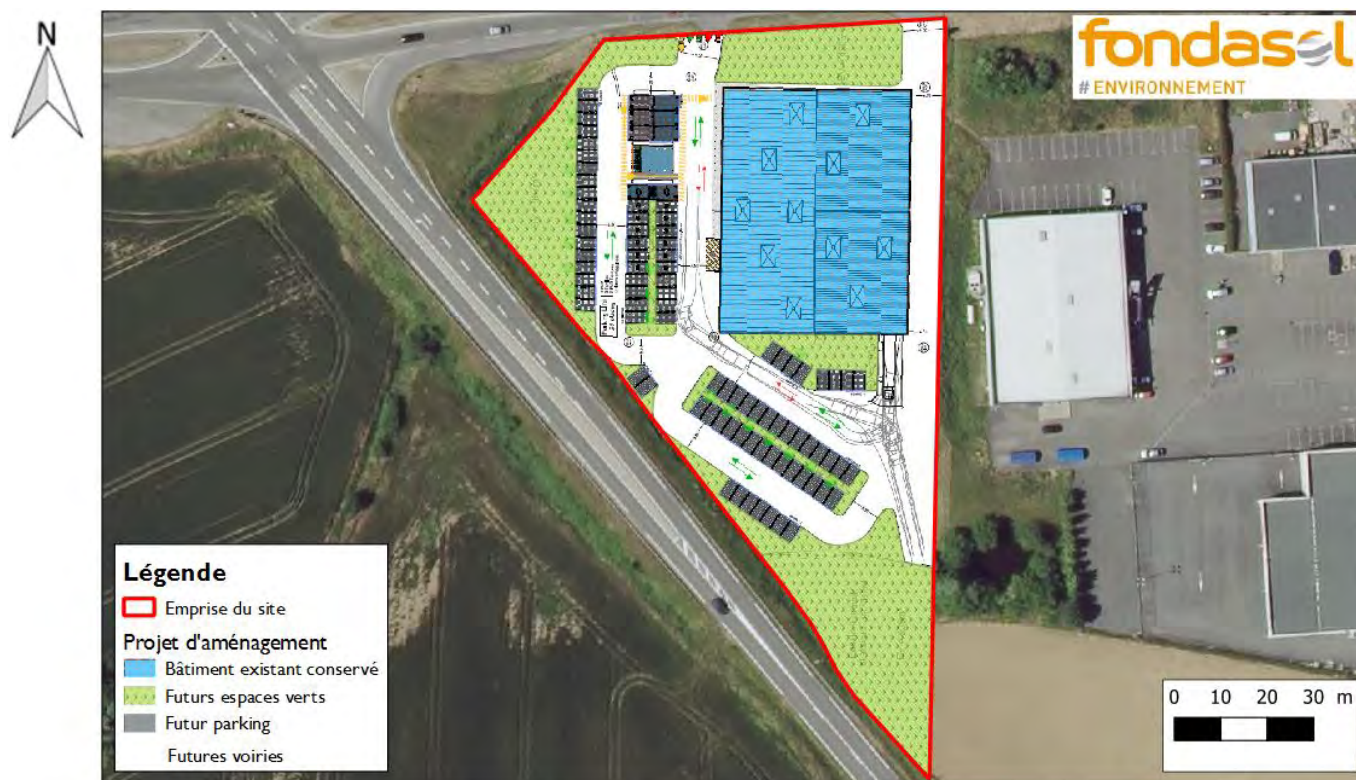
Plan de masse du projet d'aménagement (Source : plan de masse en date du 27/01/2020 transmis par LIDL)
